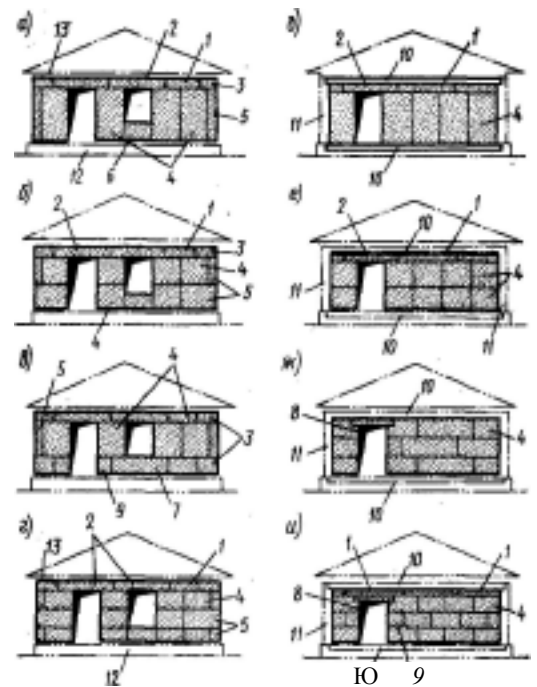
Схемы разрезки стен одноэтажных жилых зданий на крупные блоки:
